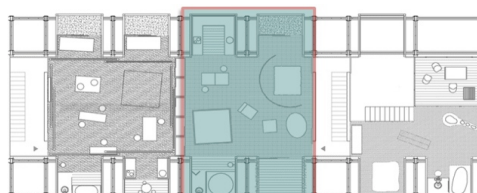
Planta Piso 1, Apartamento para 1 casal
